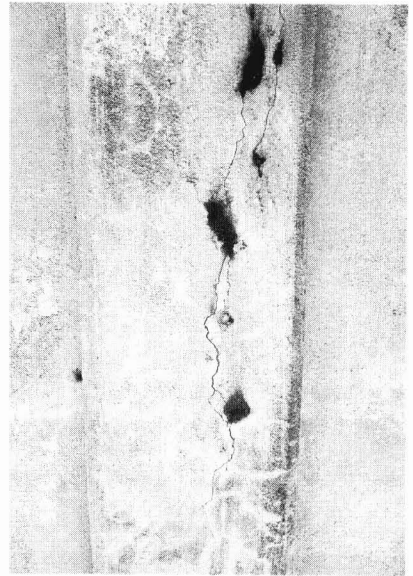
豊見城団地柱の主筋に沿ったひび割れの損傷状況
